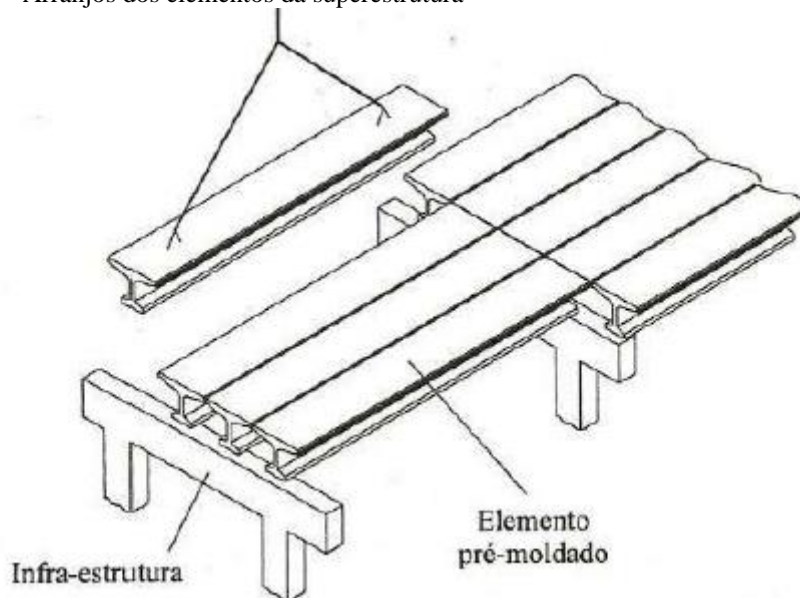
Seção transversal tipo I de uma ponte rodoviária com vigas pré moldadas
